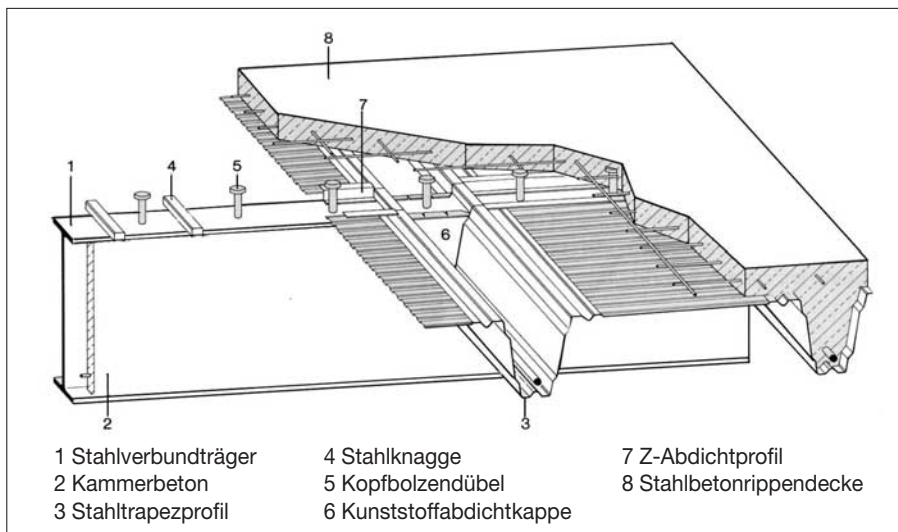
Stahlflachdecke mit tiefen Trapezprofilen „Slimdek“
